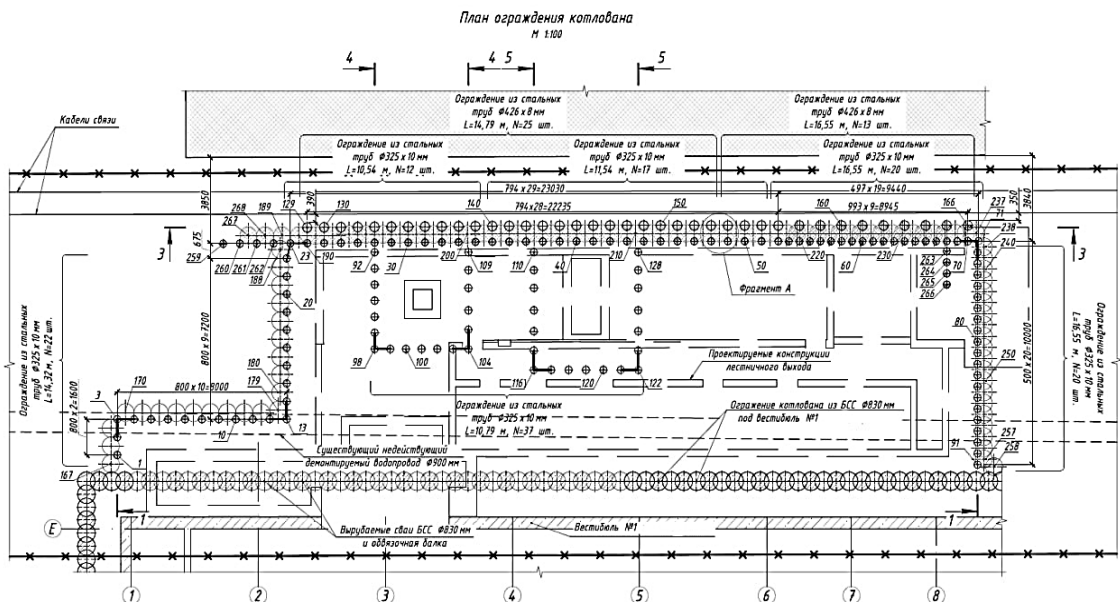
План ограждения котлована для сооружения лестничного схода
